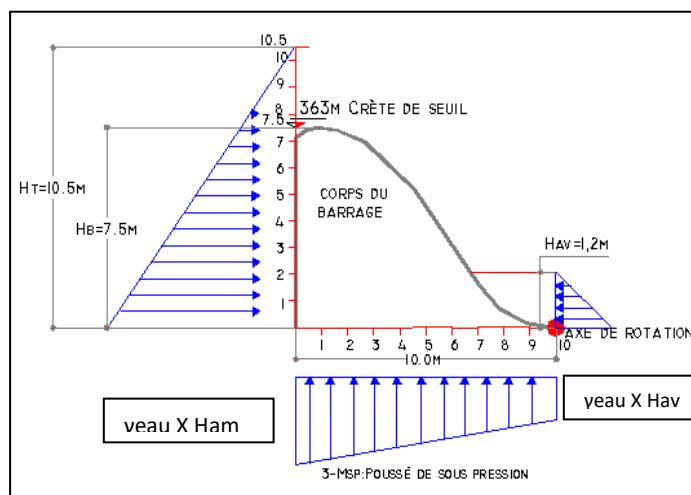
Poussée amont, aval exercée et sous pression sur le corps du barrage
